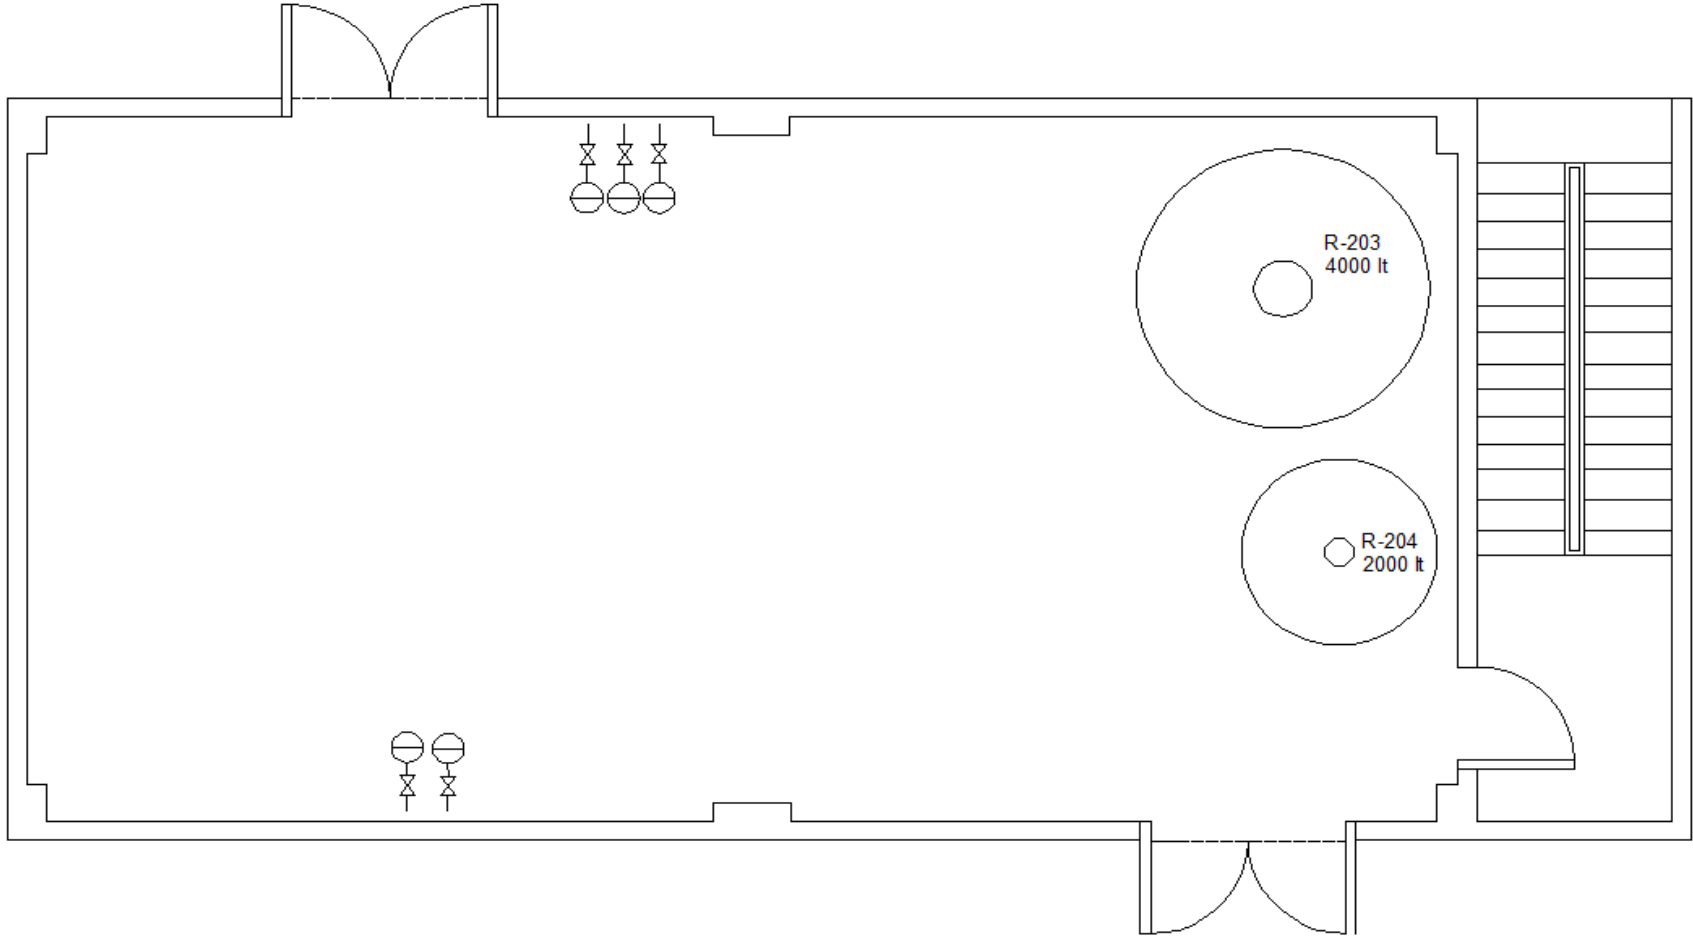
Depolama tankları ve kollektör odası yerleşim plan
